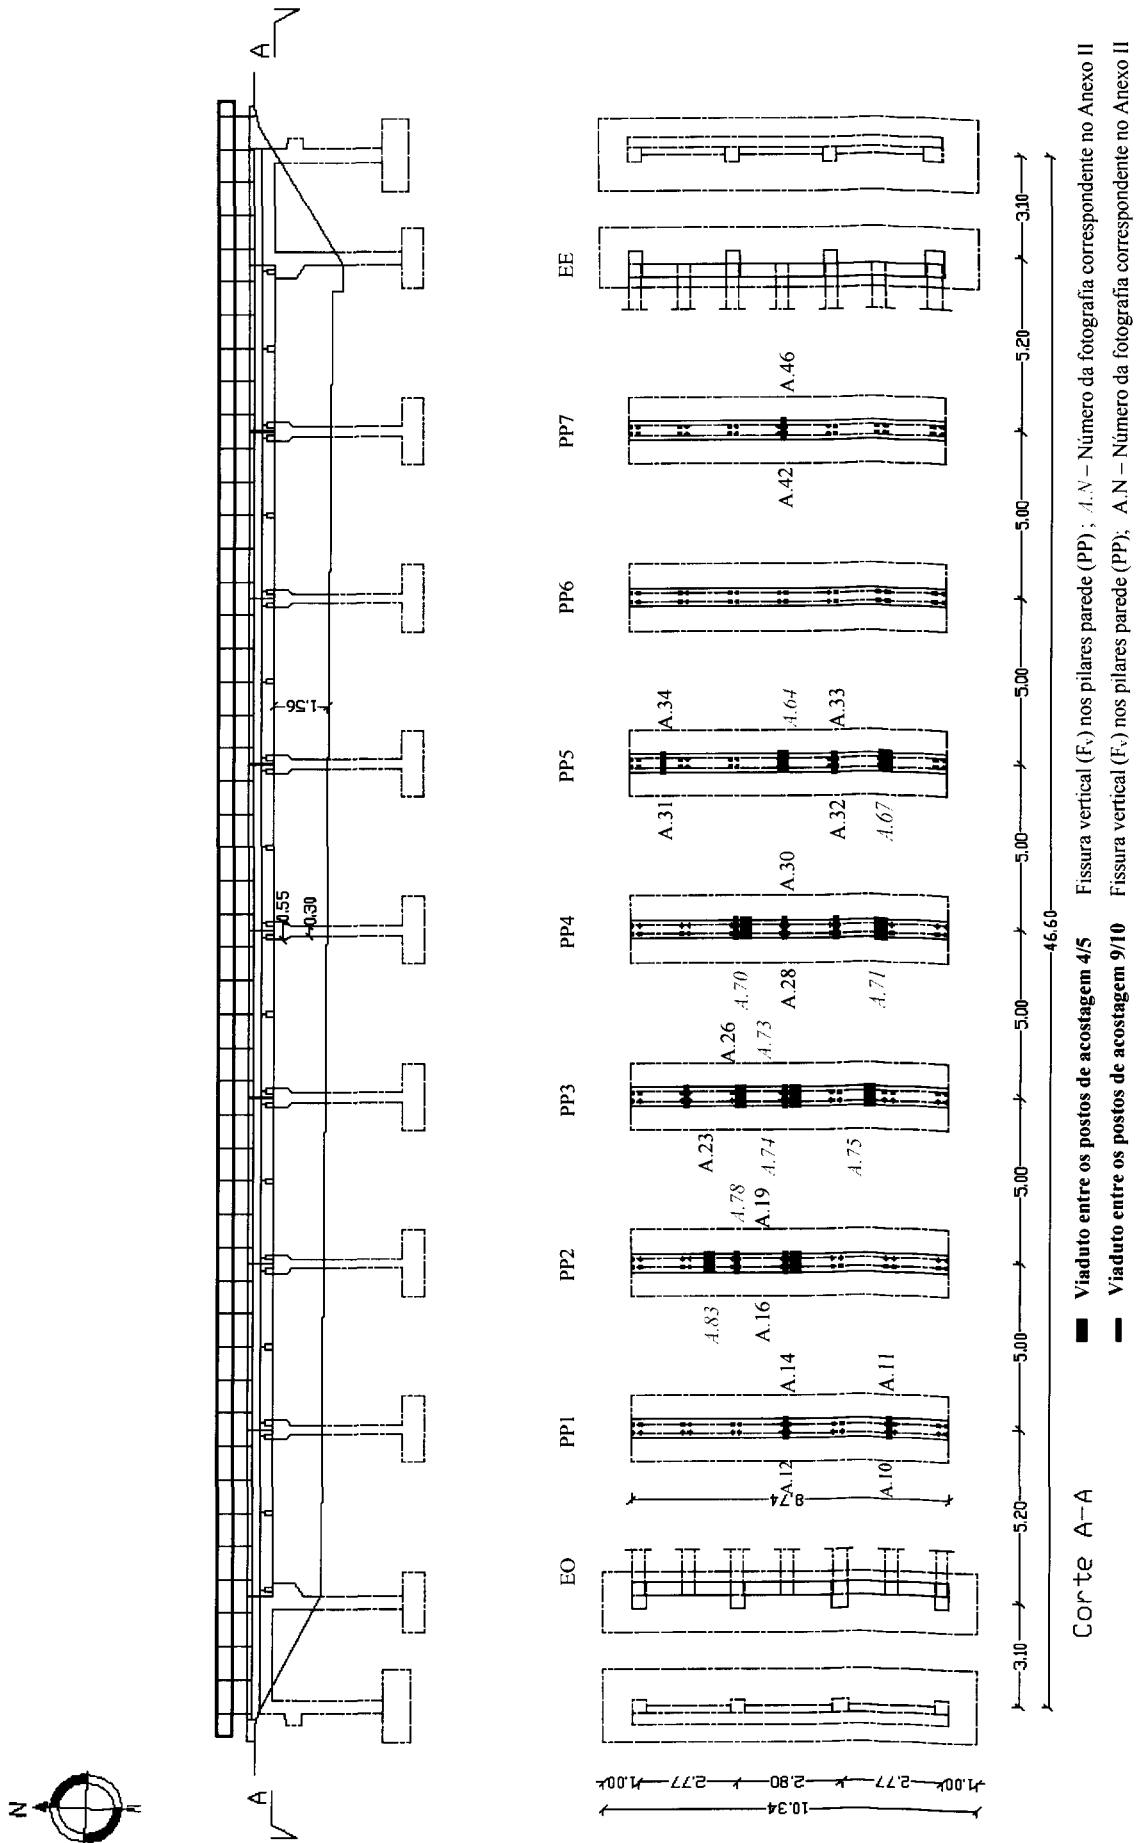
Registo das fissuras verticais nos pilares parede dos viadutos, com indicação da correspondente fotografia no Anexo II
